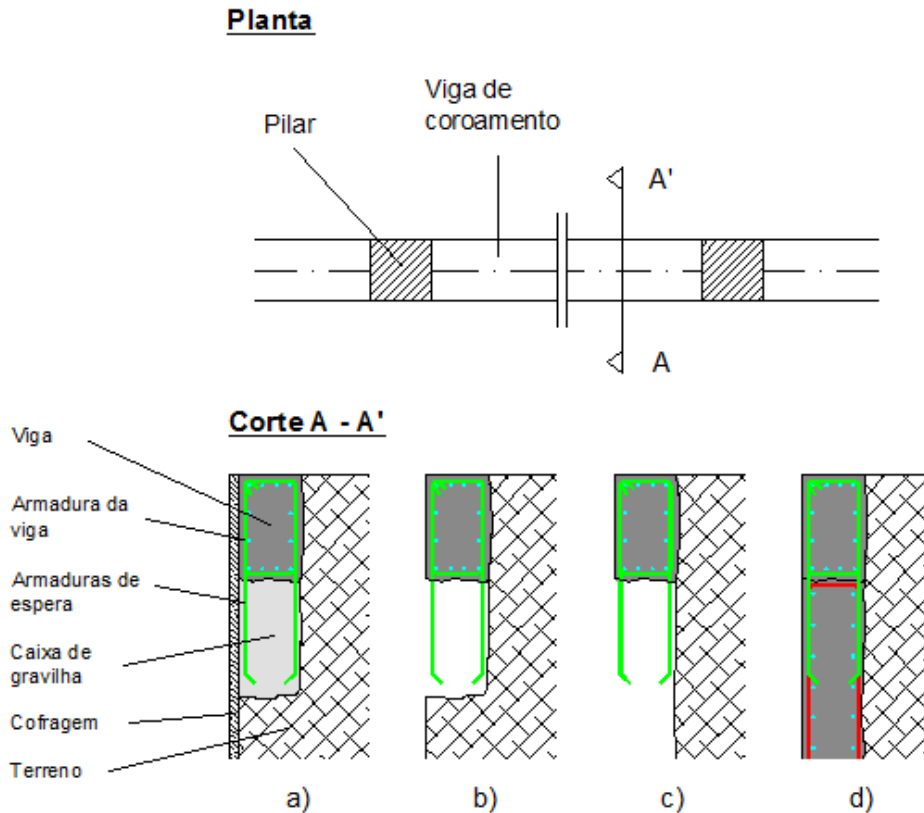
Processo construtivo da viga de coroamento do muro de suporte na ligação entre pilares
